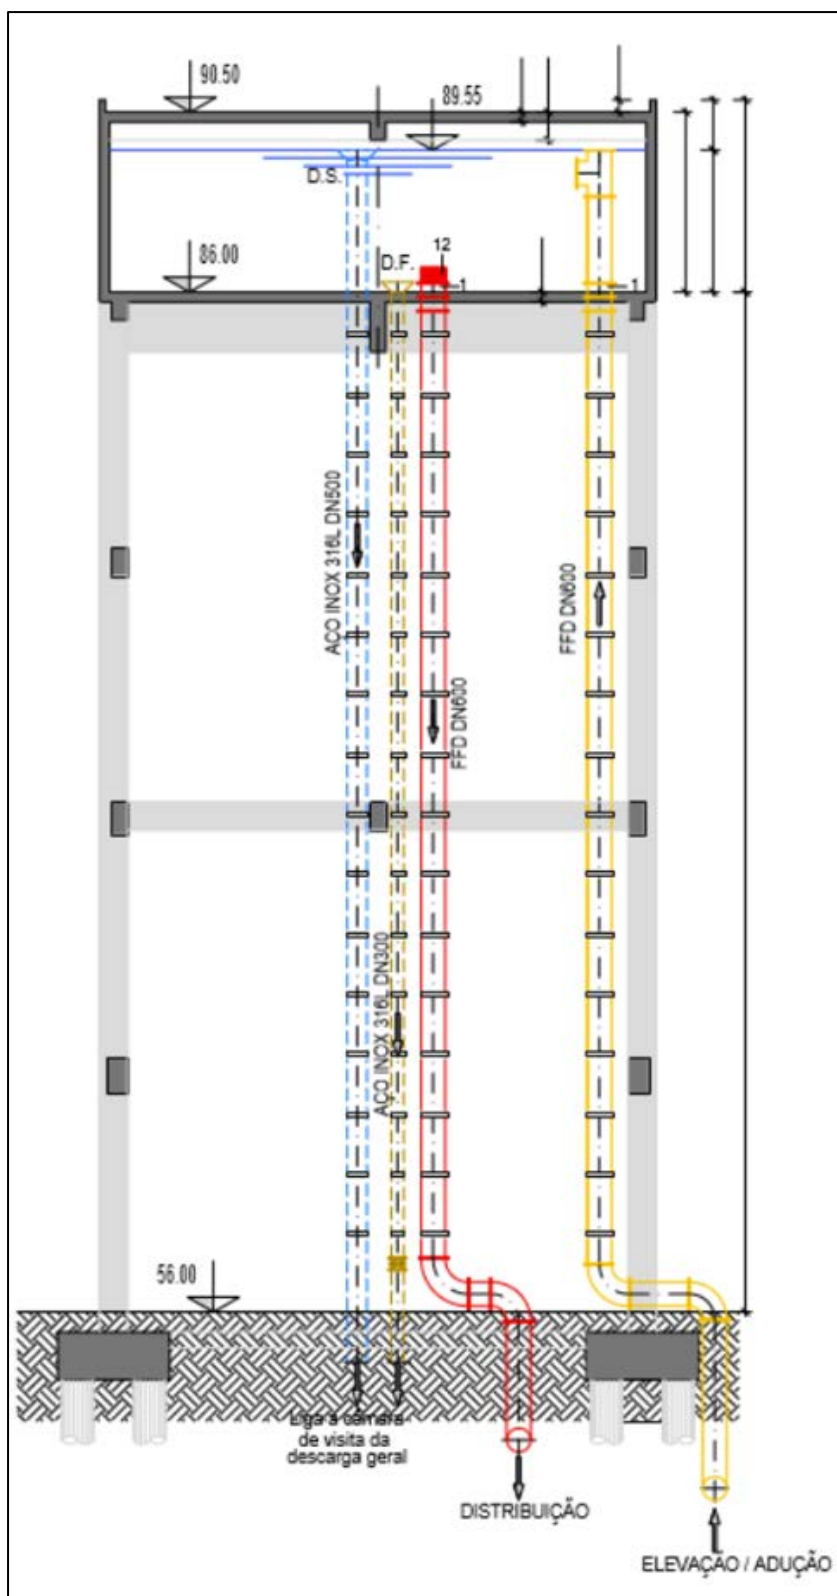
Secção transversal do reservatório elevado (Fonte: CentroCerro, 2025)
